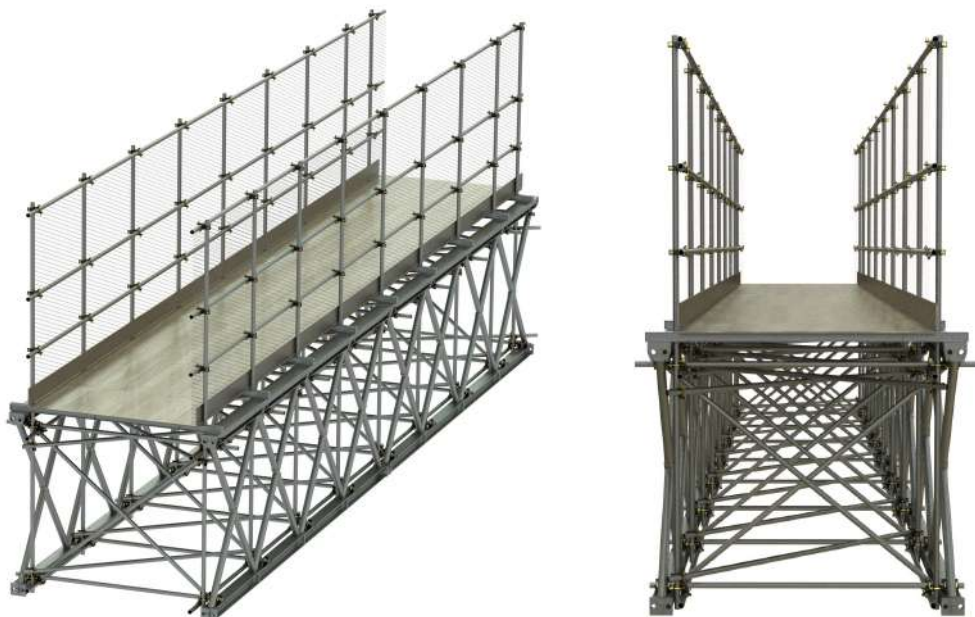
Treliça SH 300 – Passarela Contraventada por dentro
